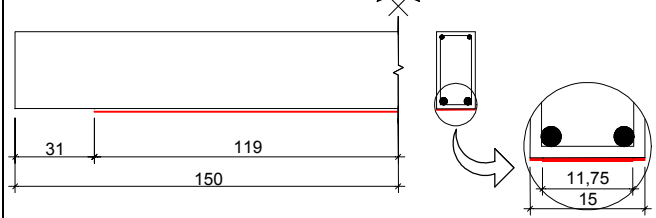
Detalhamento da armadura das vigas do grupo F
